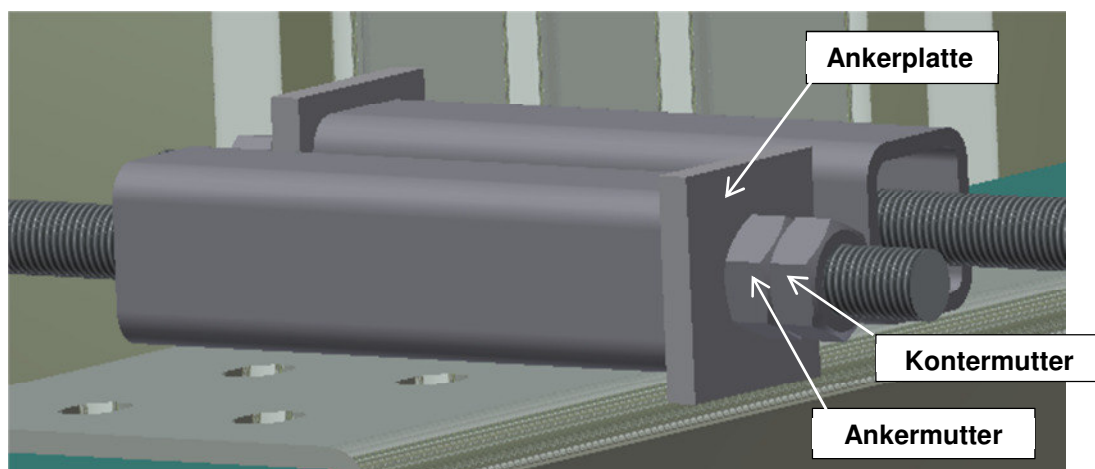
Detail Verschraubung mit Ankerplatte und Kontermutter
